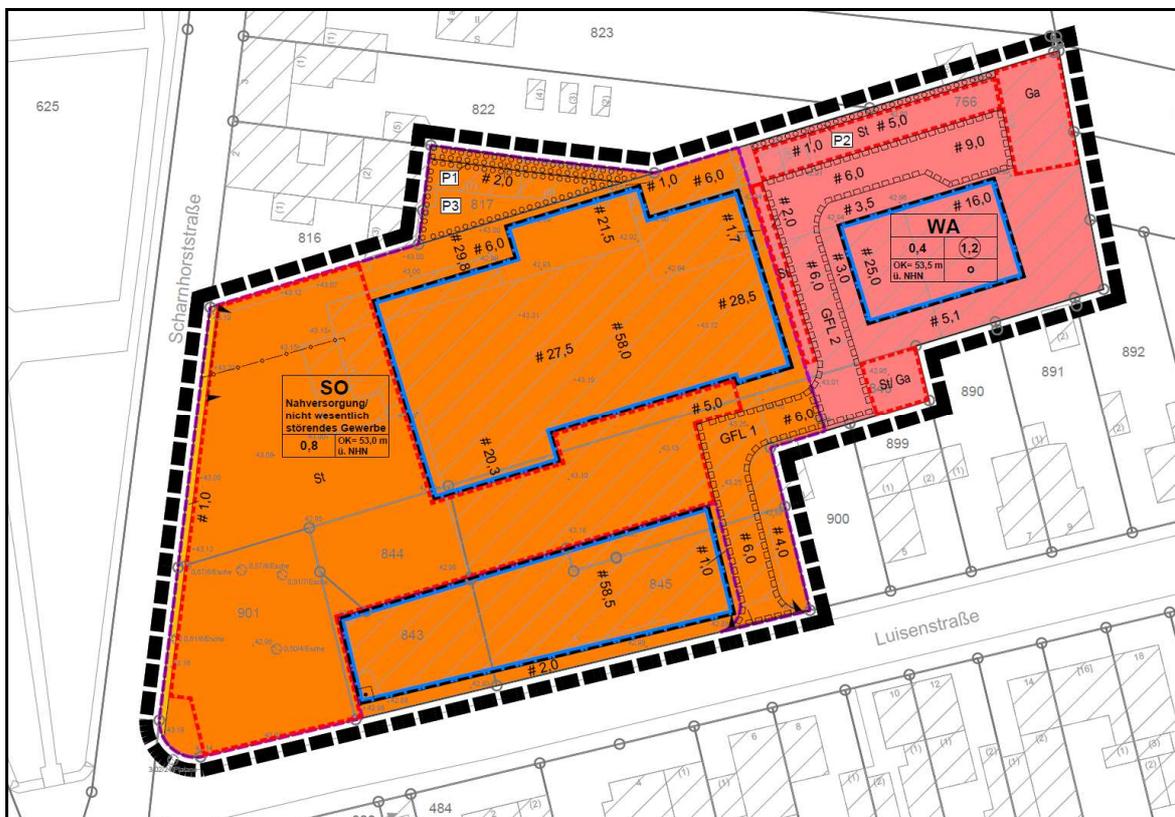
Darstellung des Bebauungsplans Nr. 115 Stand: 21.03.2023
